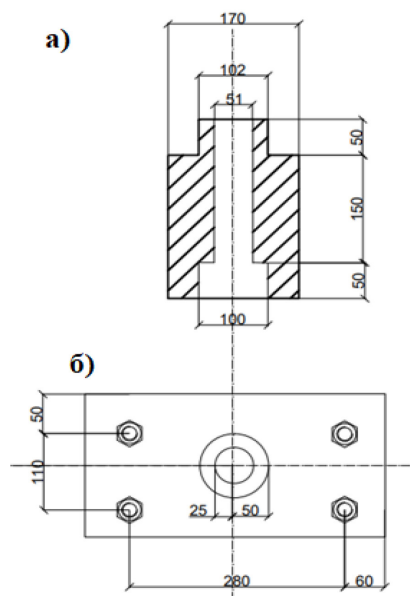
Вкладной металлический элемент, основа сборной конструкции:
